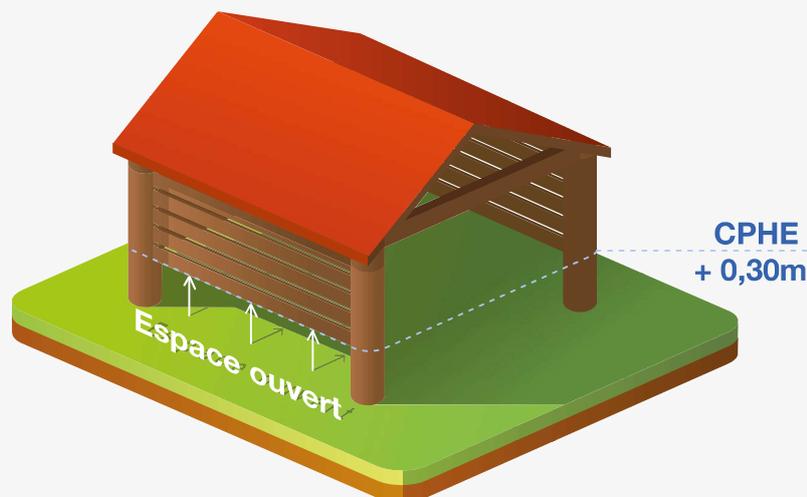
Illustration d'une construction autre qu'un bâtiment ne comportant pas de paroi sous la CPHE.
